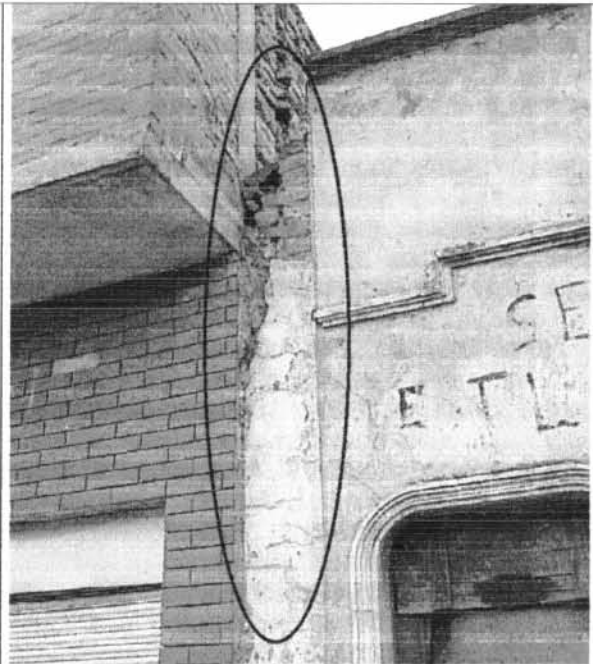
Desprendimiento de piezas de mampostería y fisuras en los muros – Costado norte de fachada.
